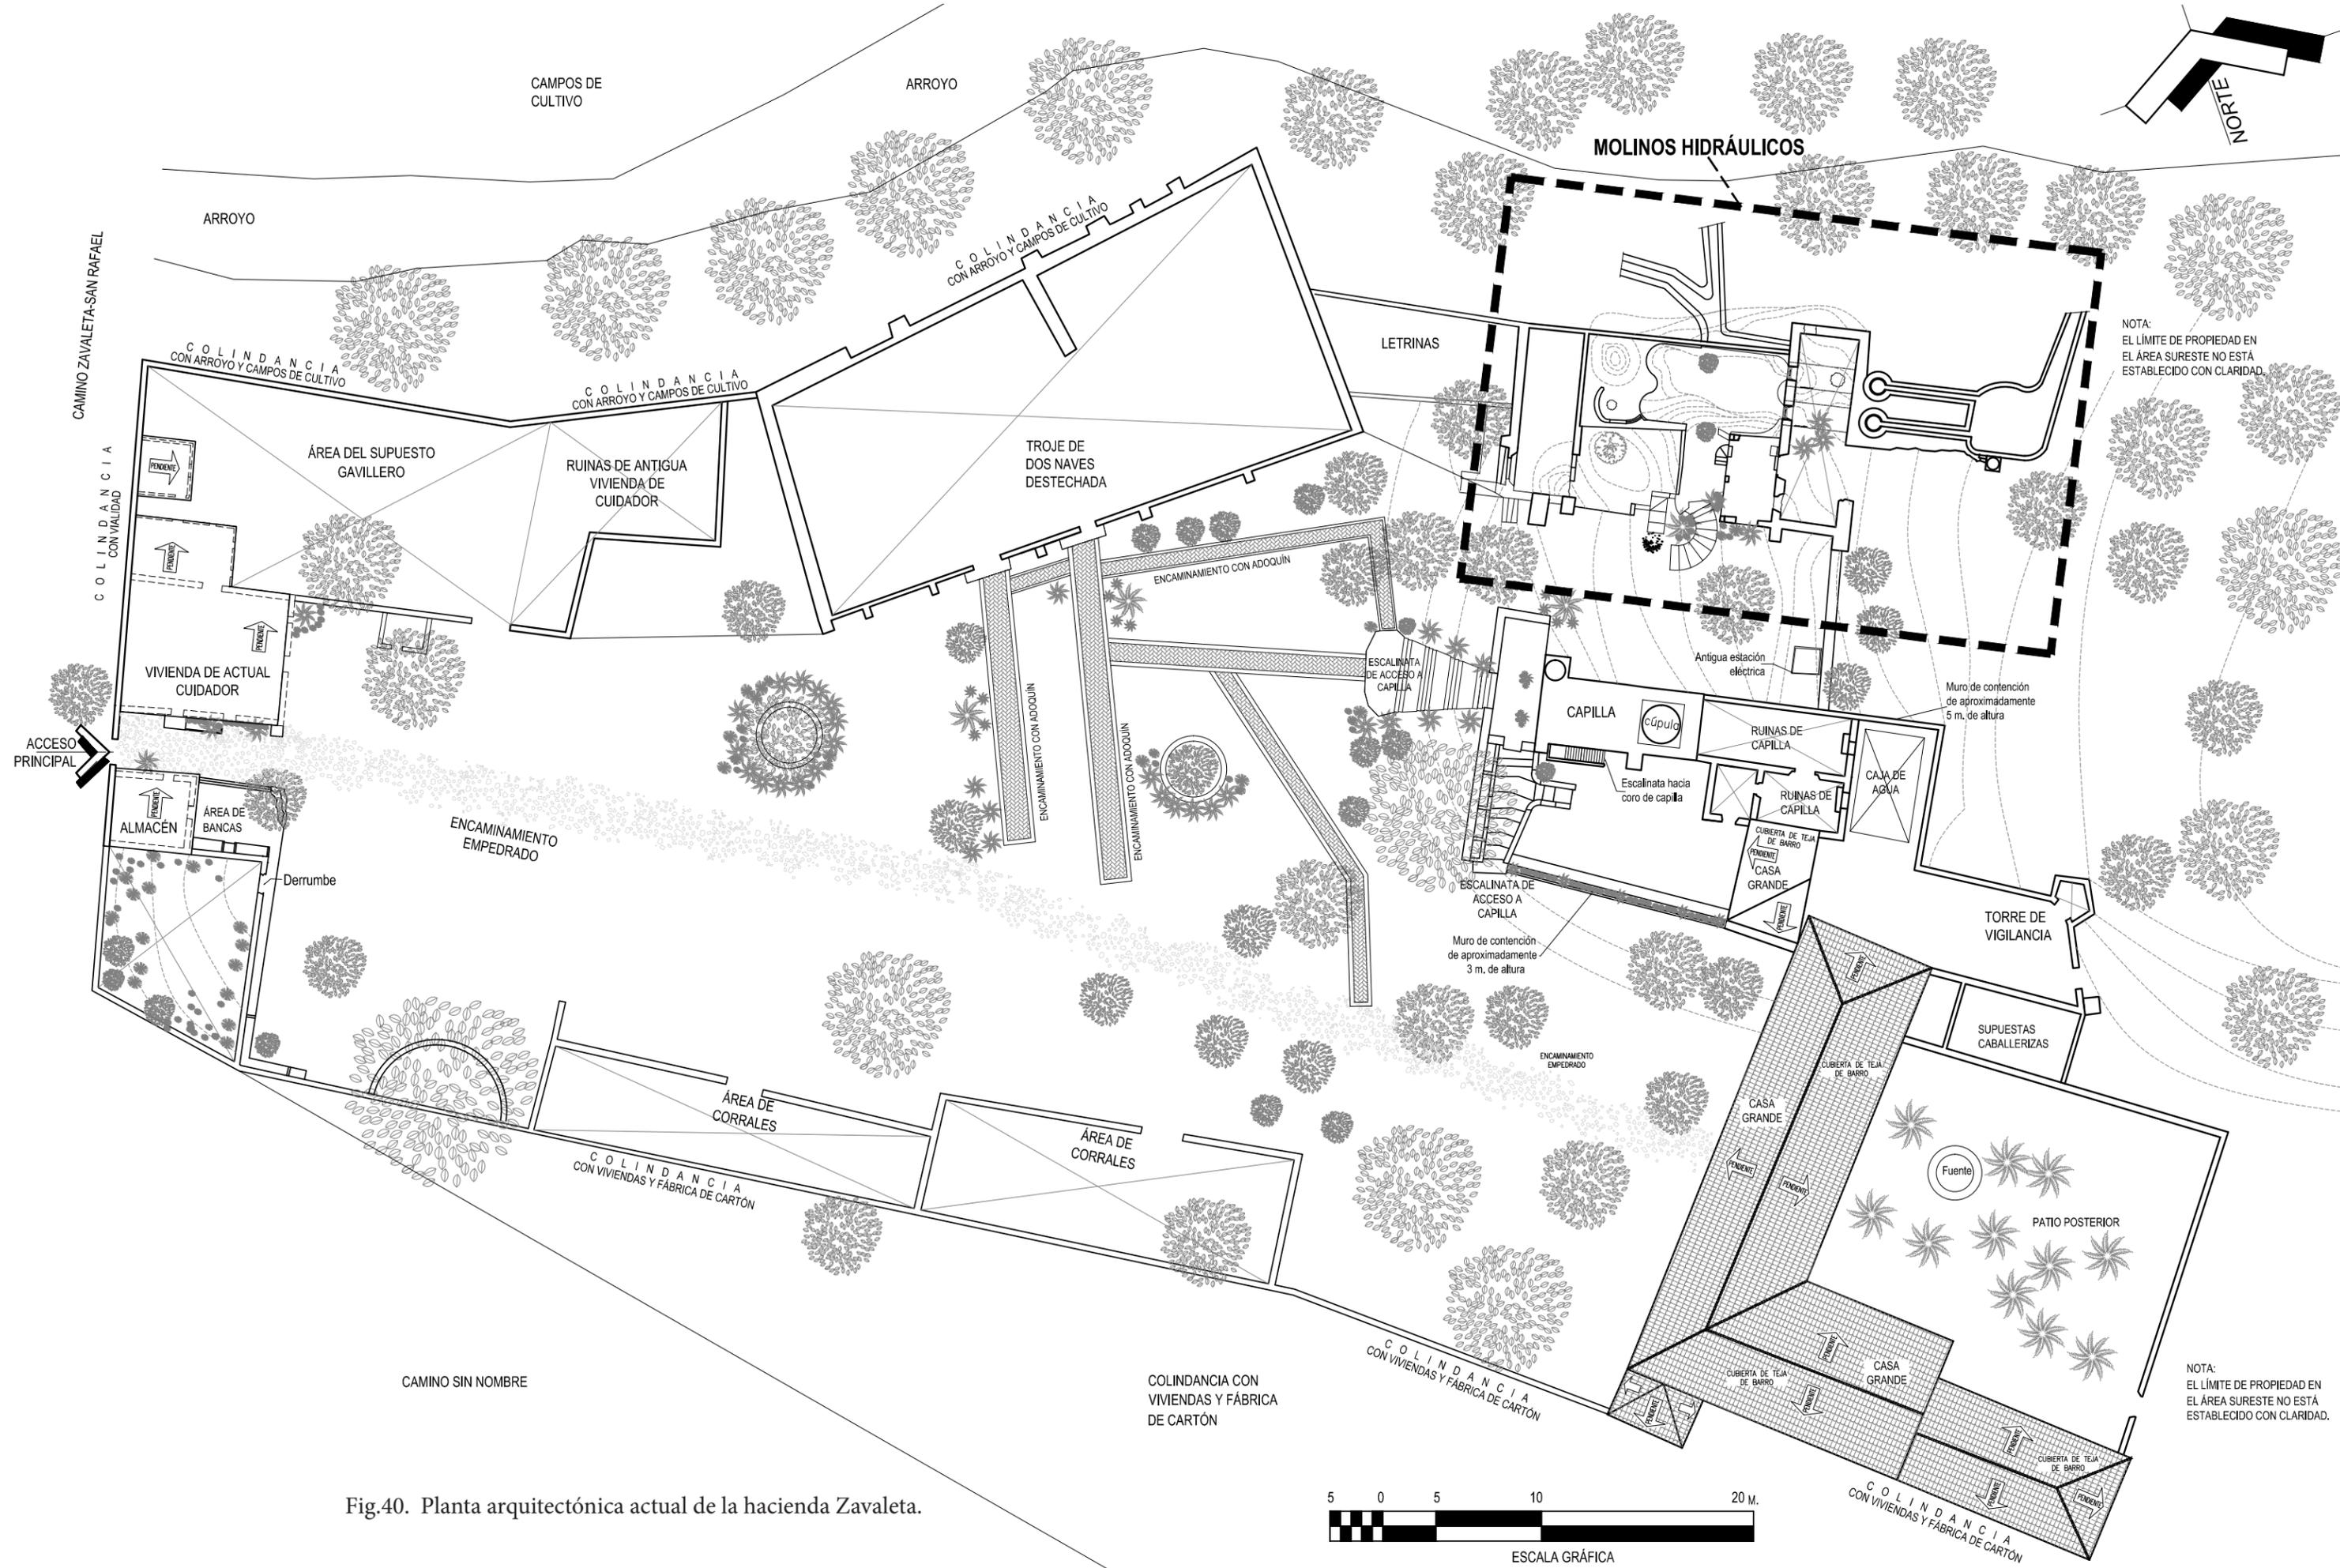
Planta arquitectónica actual de la hacienda Zavaleta.
